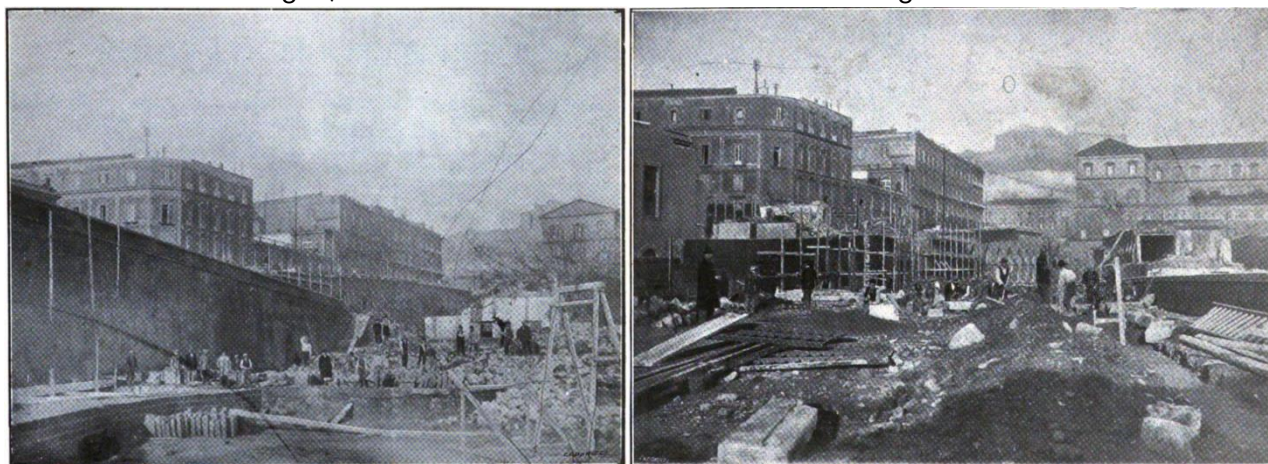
Allargamento di via Cesario Console con la costruzione della murazione
